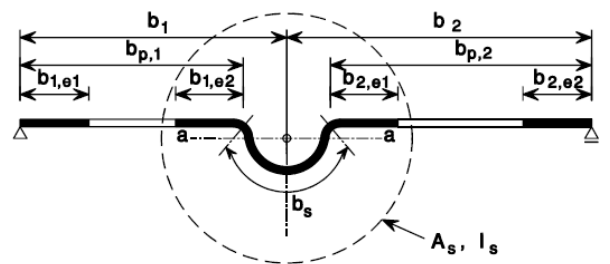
Sezione trasversale per il calcolo di A_s
